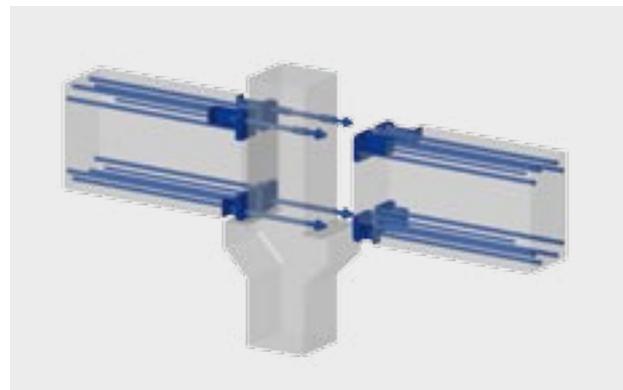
Biegesteife Rahmenecke mit Ankerbolzen und Balkenschuh
